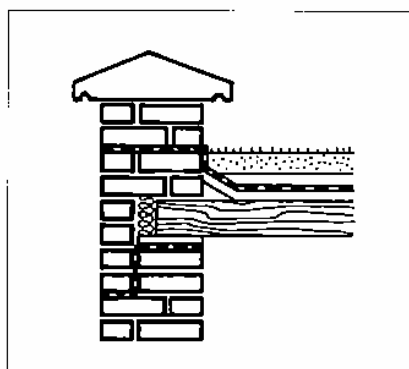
Détail d'étanchéité toiture/acrotère et toiture/mur. Noter le système souple de pose des poutres dans le mur avec isolation (pont thermique) et étanchéité sur le plan de pose.
